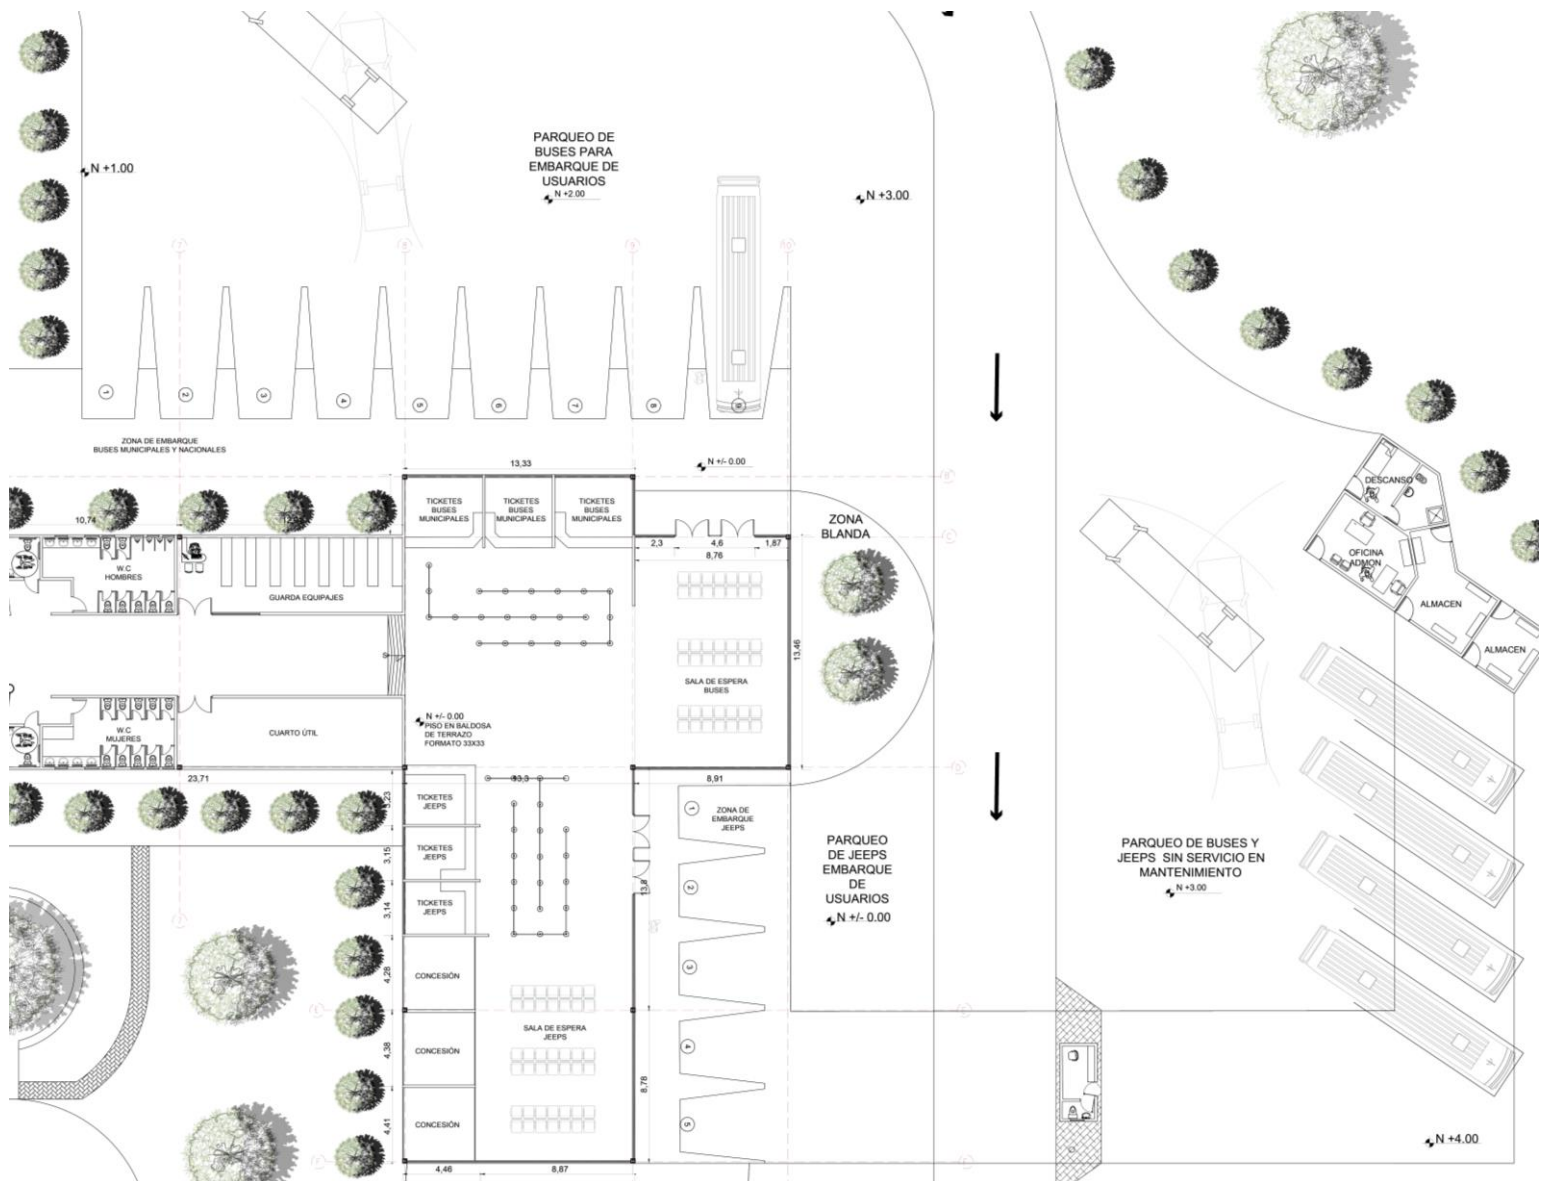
Planimetría amoblada nivel 0.00 parte 2.
